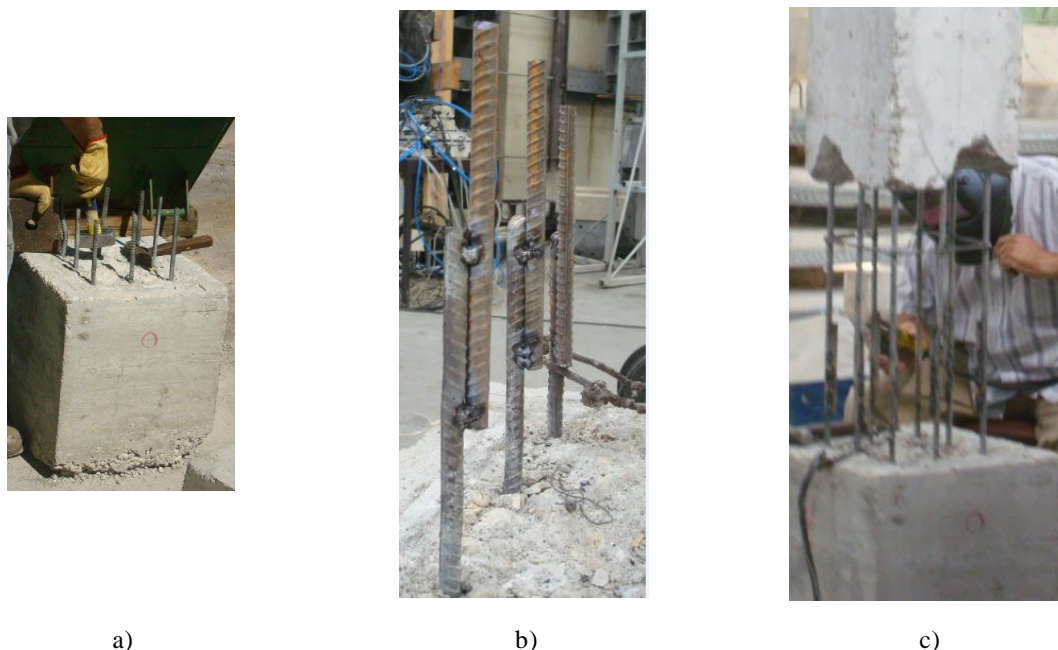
Reparação dos varões; a) Ajustamento dos varões à posição original; b) Soldadura da emenda com os varões da sapata; c) Soldadura da emenda com os varões do pilar
